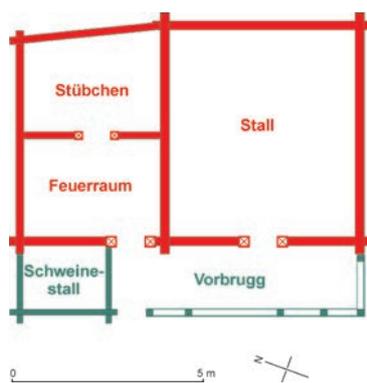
Hütte Nr. 229. Grundriss Erdgeschoss mit Bauetappen.
